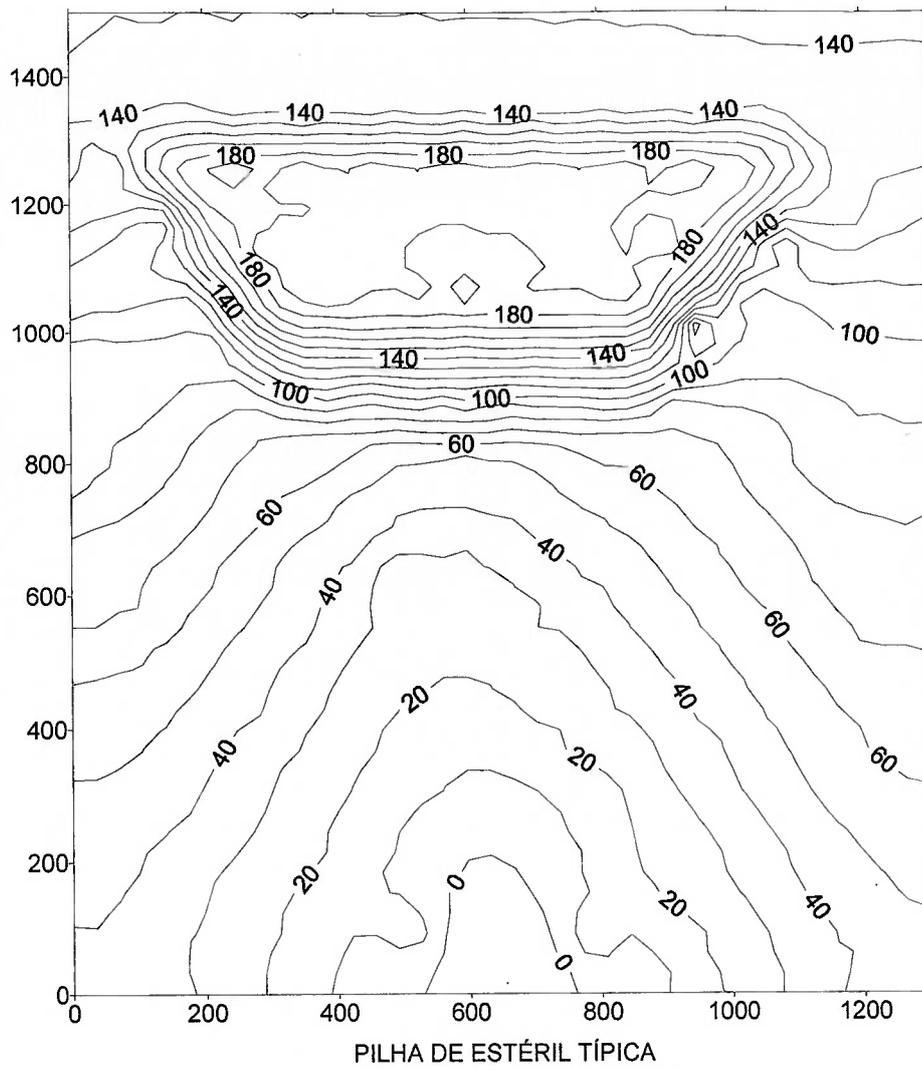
Planta planialtimétrica de pilha de estéril típica
